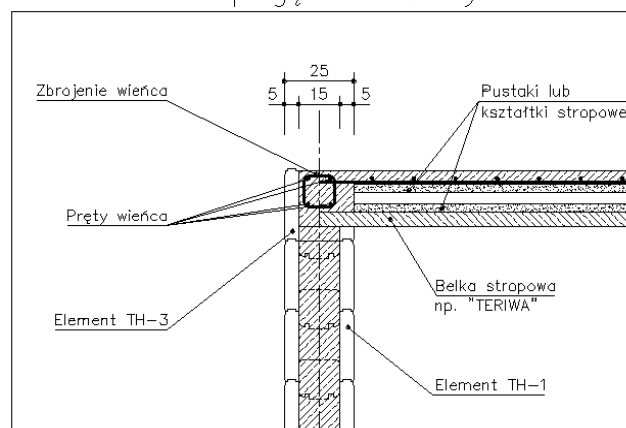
Zabezpieczenie elementu wieńcowego przed wypchnięciem przez beton podczas zalewania wieńca
